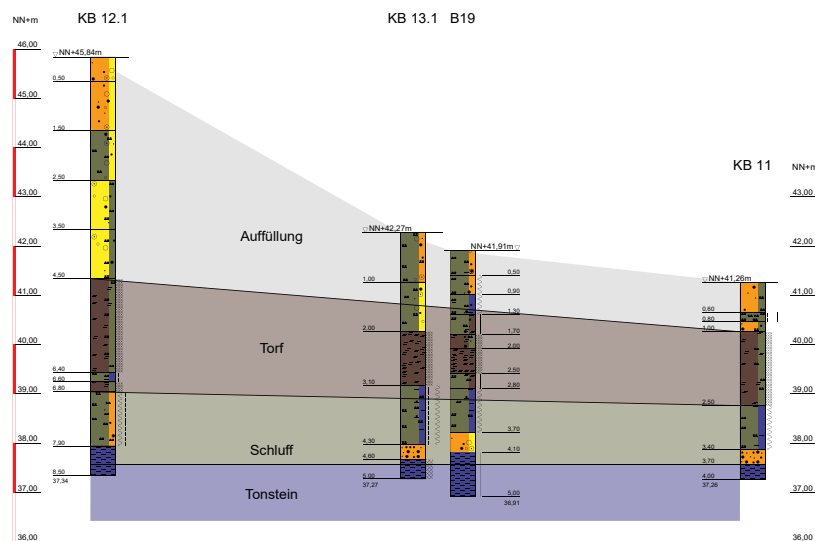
Neubau Weserschleuse Minden Rampenbauwerk UH-Brücke, Bauabschnitt III
